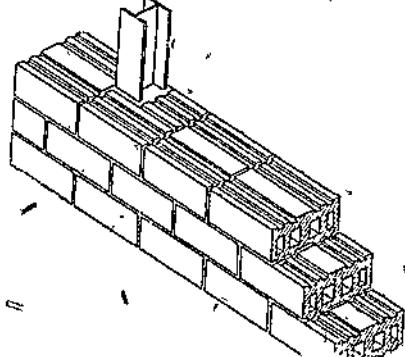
Кладка стены из блоков с долевыми отверстиями.
